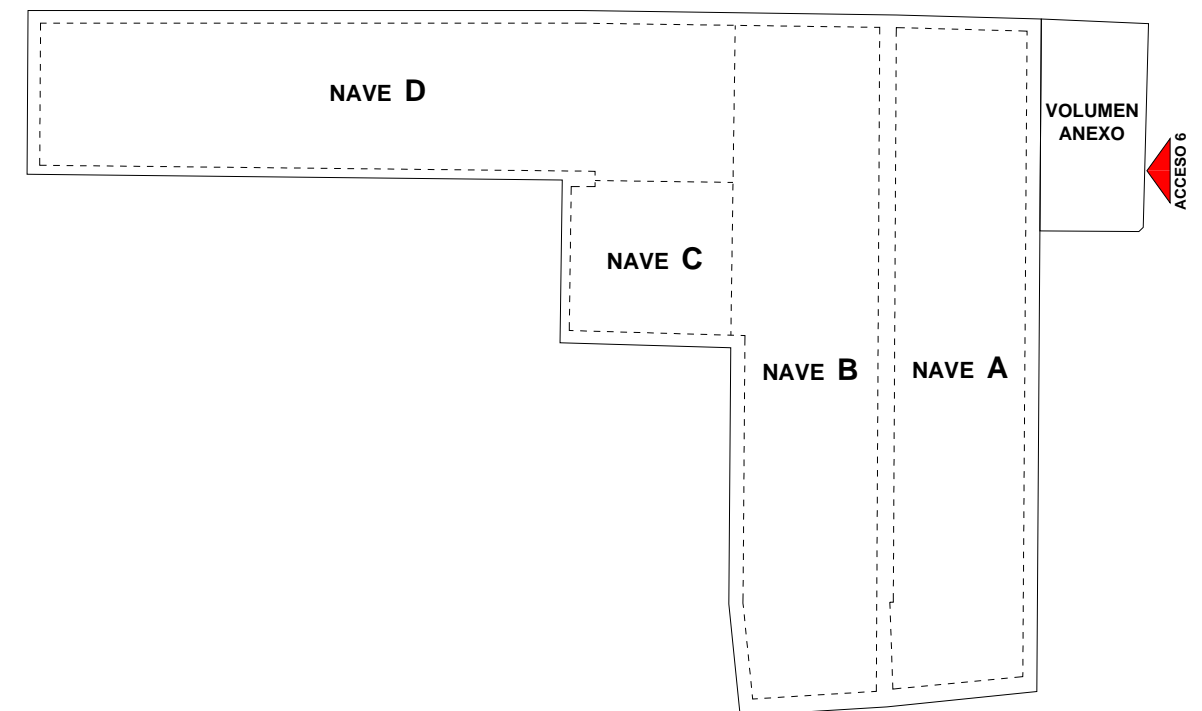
ACCESO PLANTA BAJO CUBIERTA
